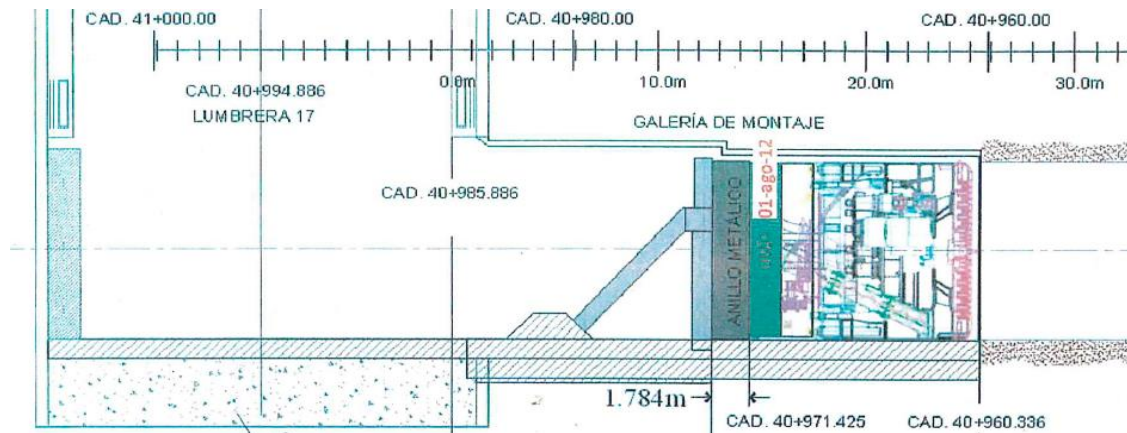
Diagrama de TBM en posición de arranque dentro de galería de montaje.⁶⁴
